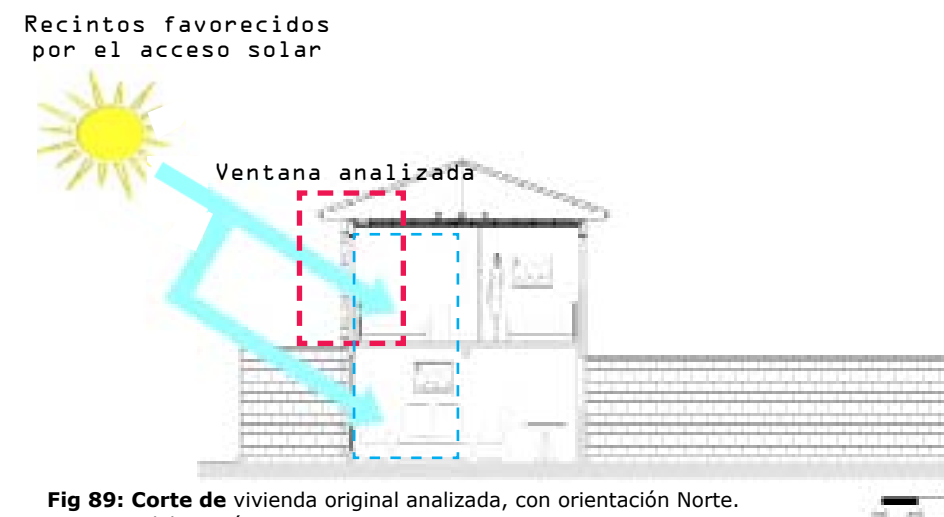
Corte de vivienda original analizada, con orientación Norte.
